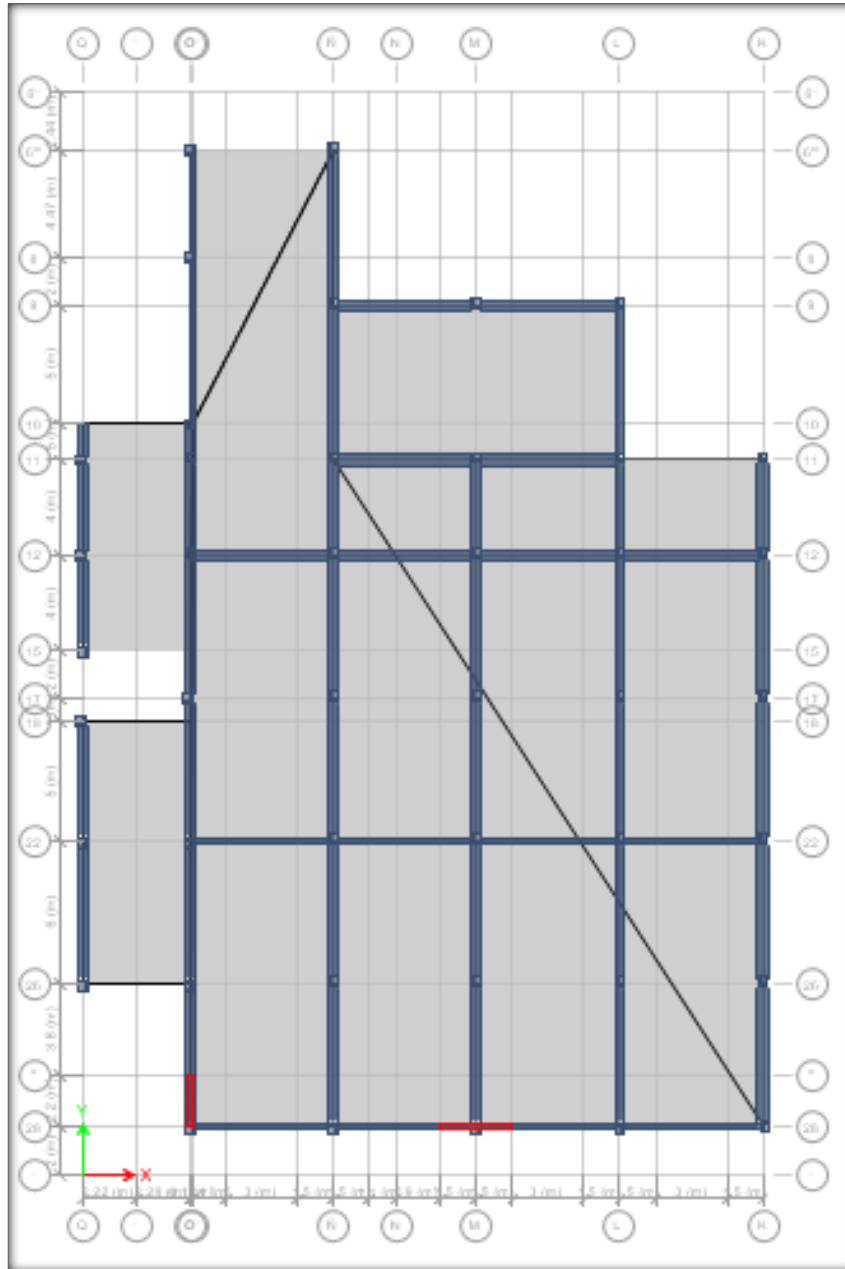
Esquema de ubicación de muros en concreto, Estructura 5.31 Hotel
